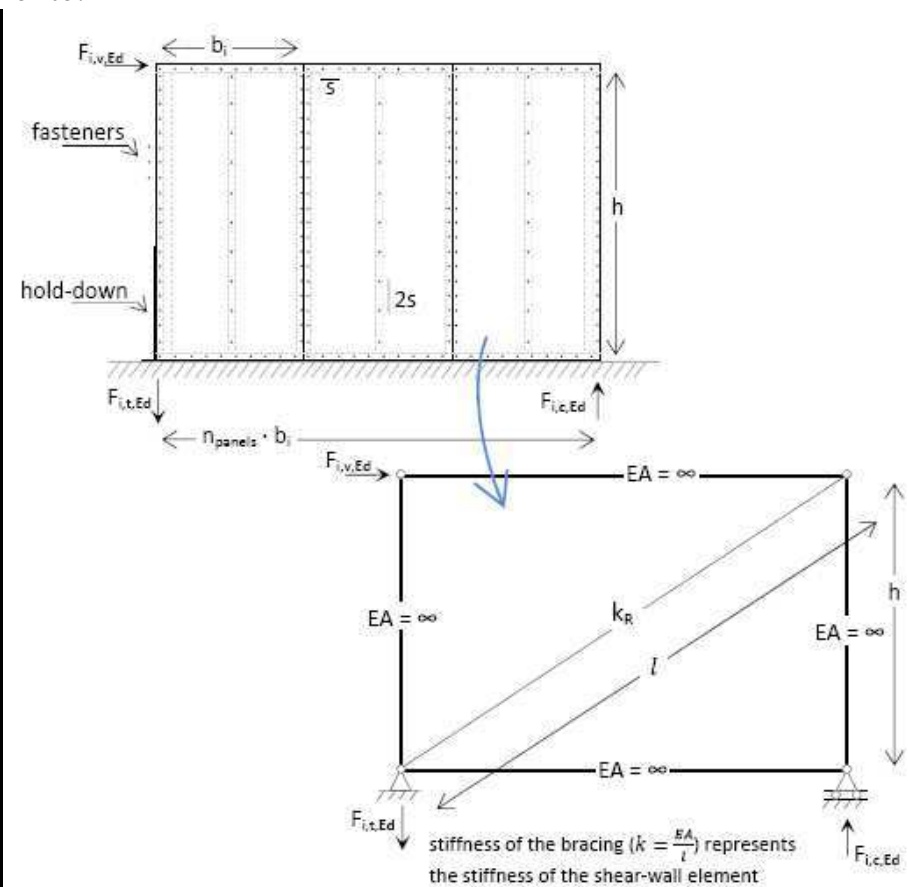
Tunis Hoeskstra, 2012, "Multi-Storey timber building*.
